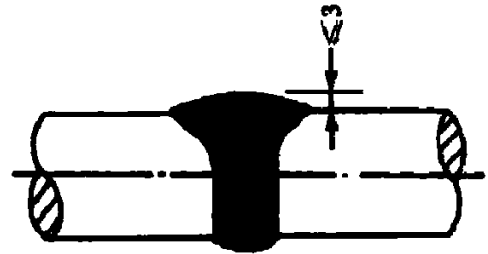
钢筋熔槽帮条焊接头
